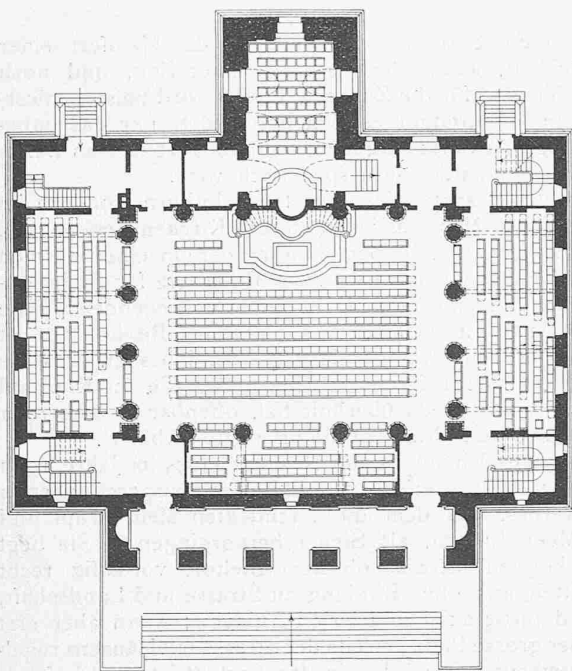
Grundriss vom Erdgeschoss. — 1 : 400.
